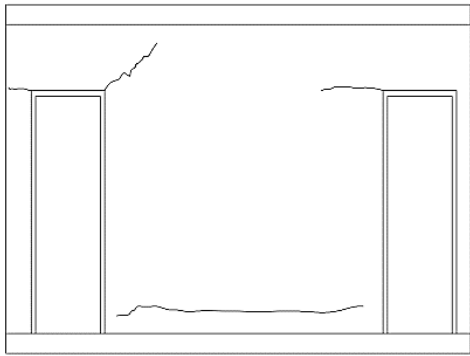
Fisuras en los muros bajo las vigas/
